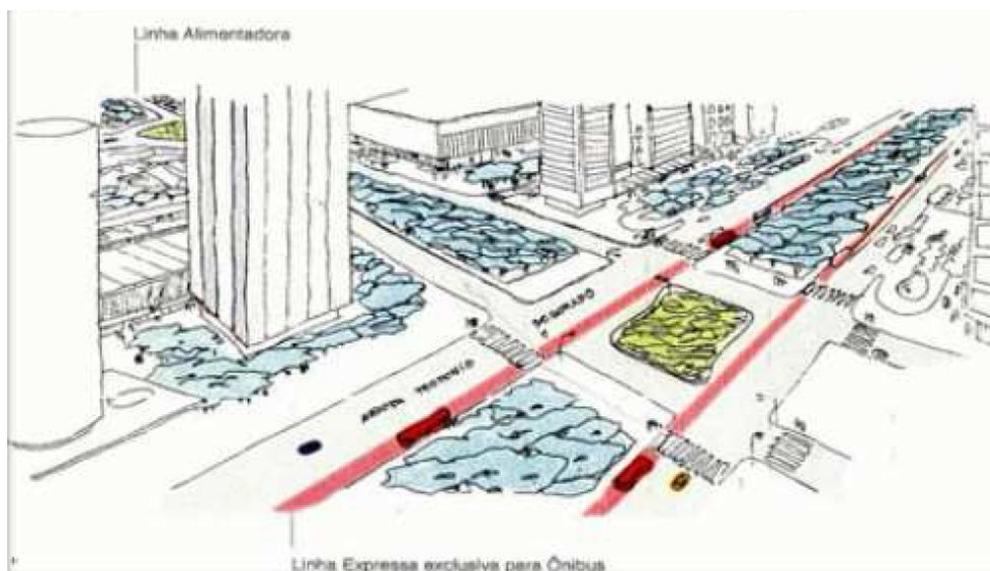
Croqui perspectivo da Avenida Teotônio Segurado com demarcação do trajeto do transporte de massa em vermelho. Fonte: GrupoQuatro. Acesso: mai. 2014.
